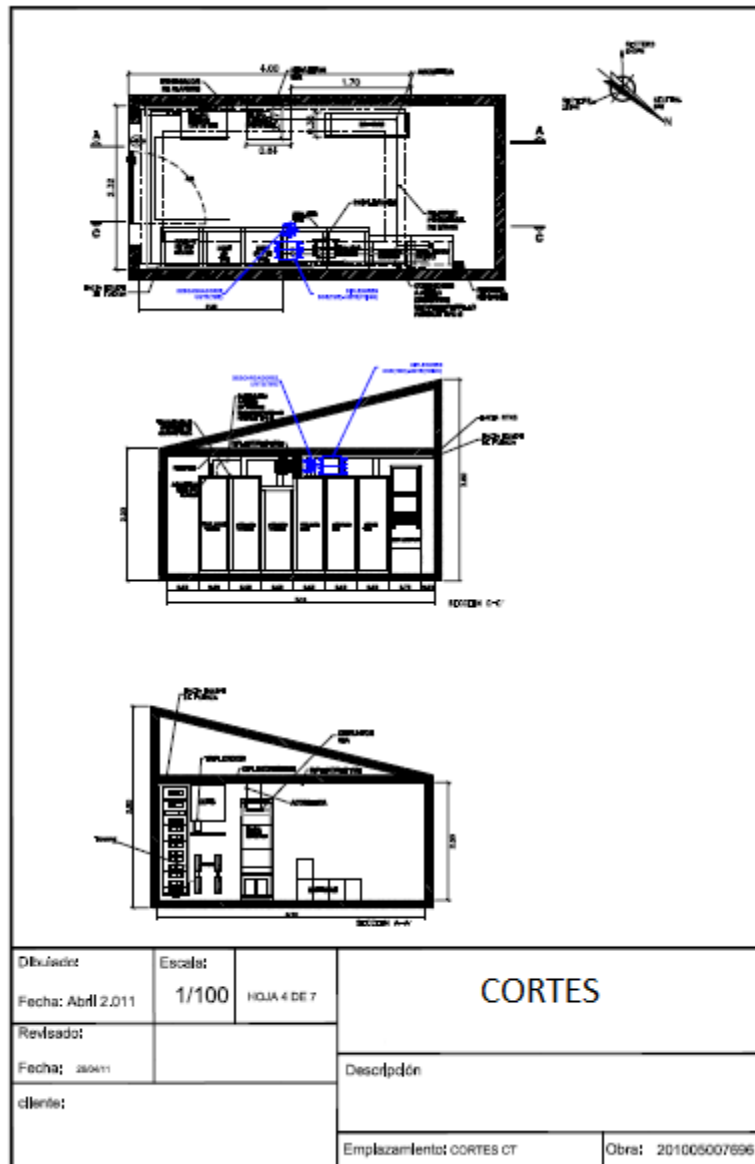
Plano planta zona de equipos y torre Cortes.
